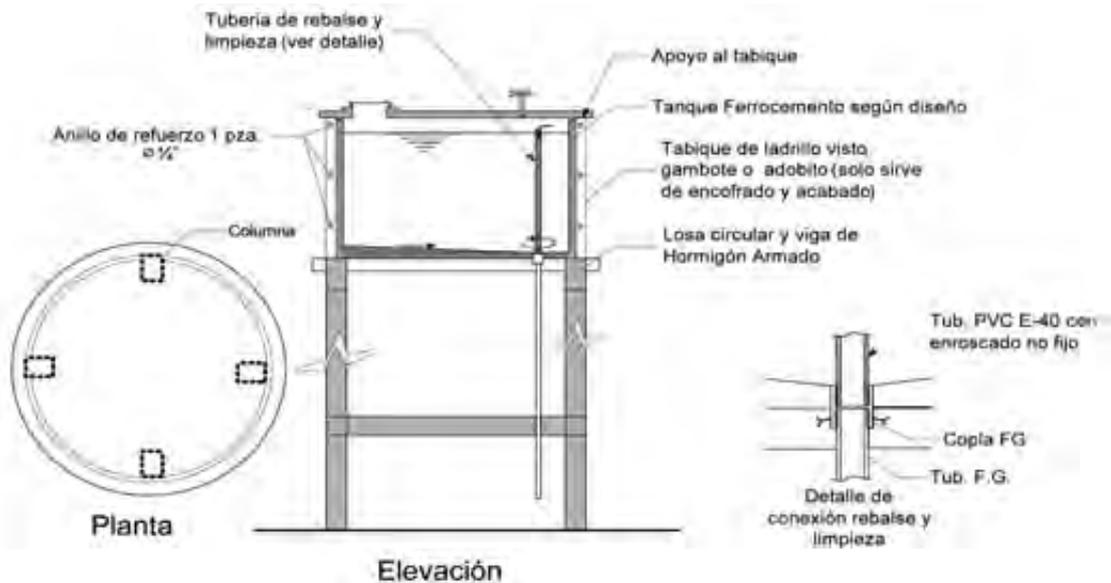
Alternativa de tanque de ferrocemento para tanque elevado
